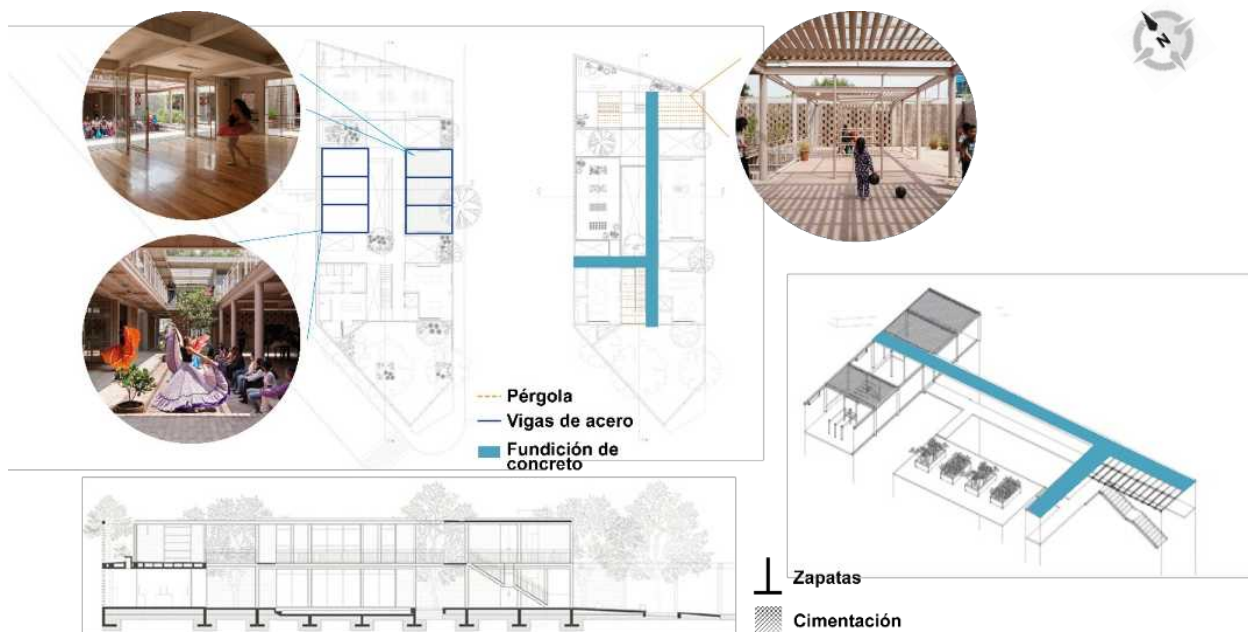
Análisis estructural. Centro Cultural Pilares Itztapalapa, México.
